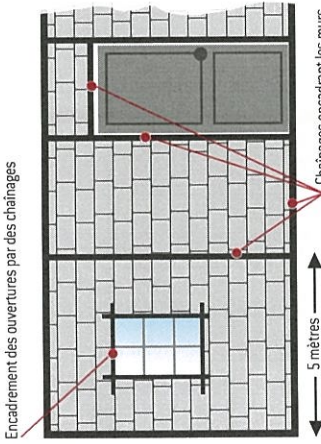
Ajout de chaînages horizontaux et verticaux encadrant les maçonneries (élévation)
